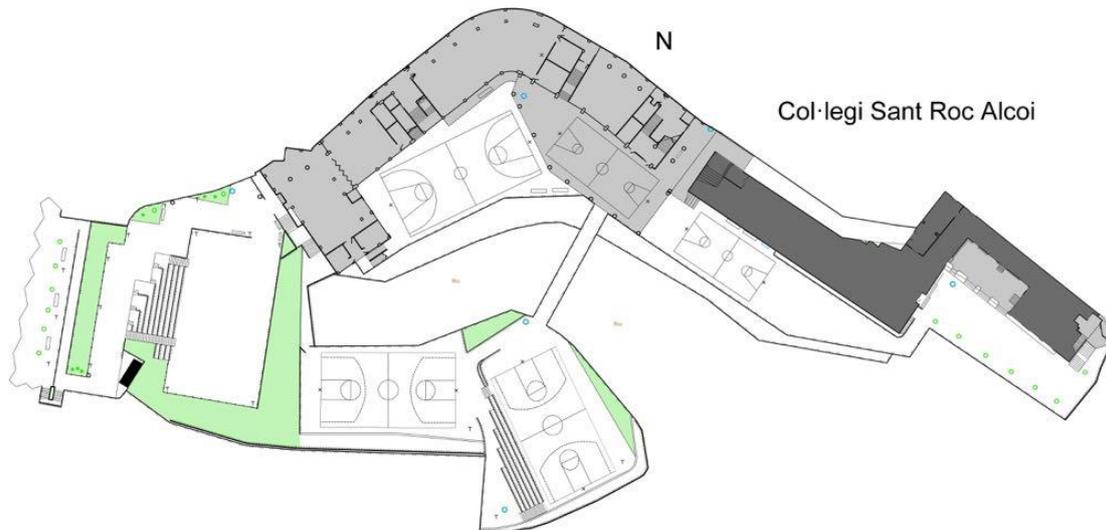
Col·legi Sant Roc - Plano actual y completo
